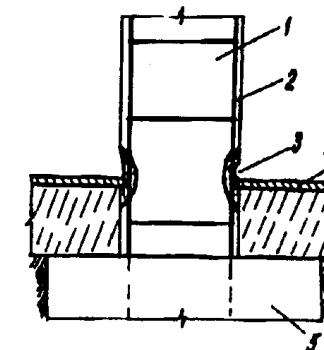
Разрушение бетона и арматуры колонны в гальваническом цехе из-за пролива на пол кислот:
